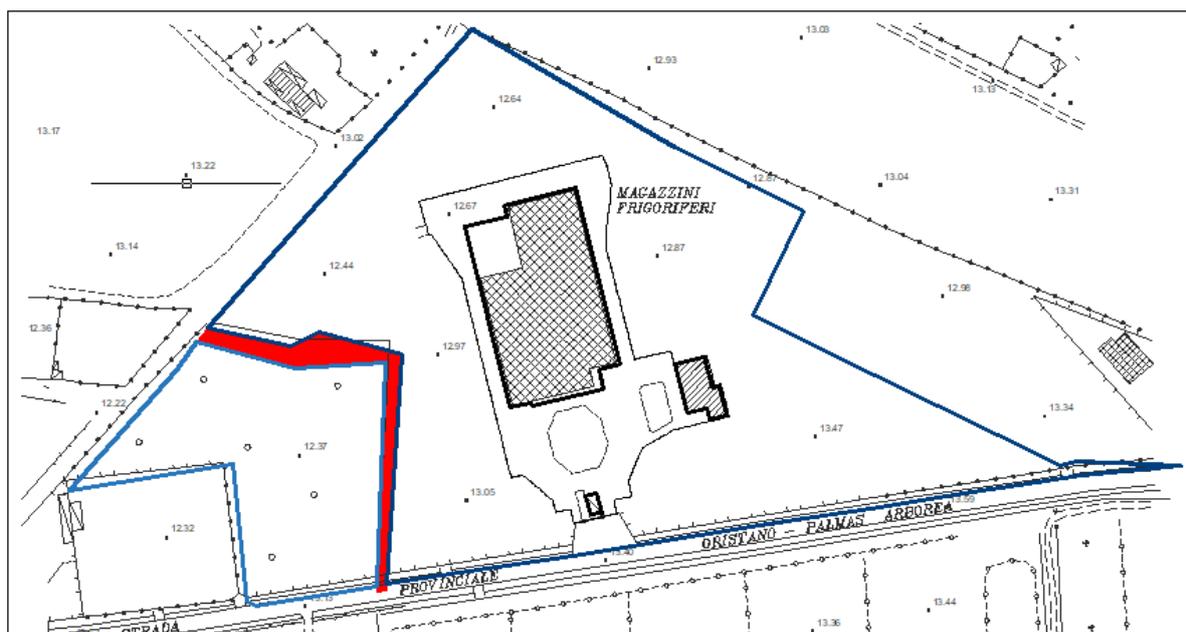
Stralcio CTR sezione 528080 - in blu la lottizzazione
